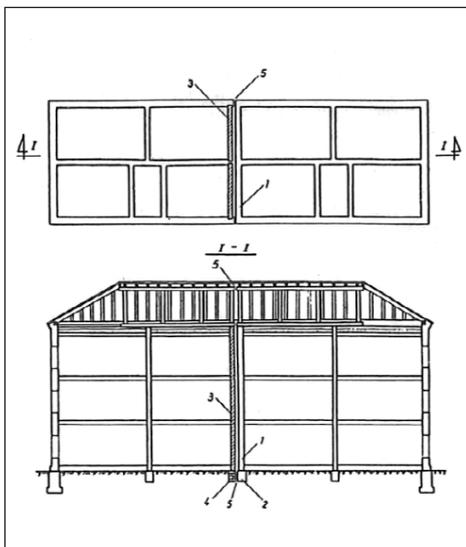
Схема разрезки здания на отсеки: 1 – существующая стена, 2 – существующий фундамент, 3 – вновь возводимая стена, 4 – вновь возводимый фундамент, 5 – деформационный шов
